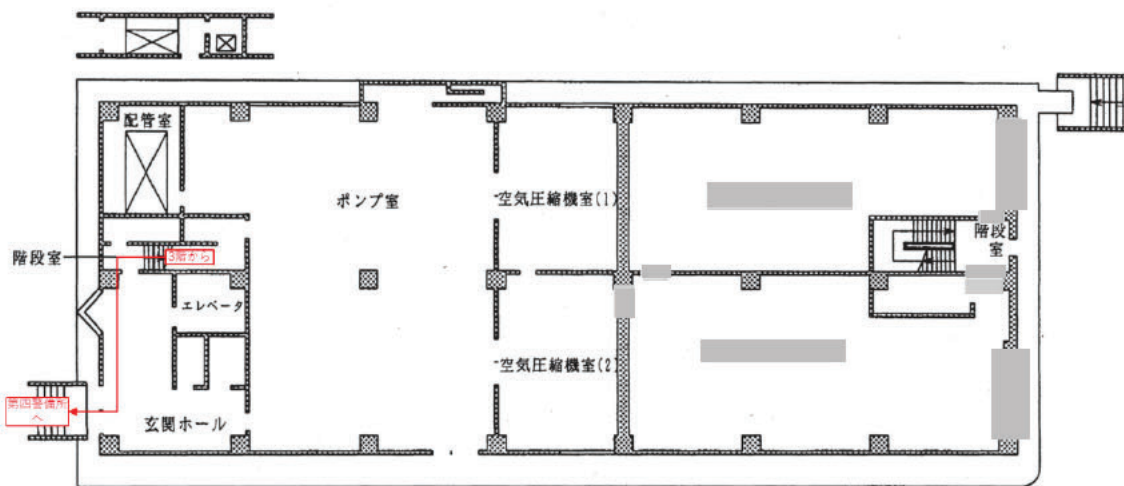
(2) 移動経路 (ユーティリティ施設 地上1F 平面図)
